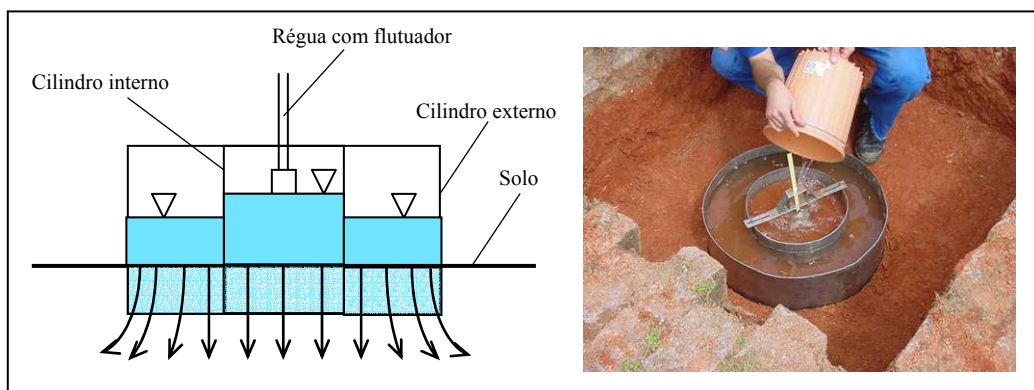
Esquema de montagem do infiltrômetro de anéis concêntricos e foto do ensaio realizado no pavimento.
